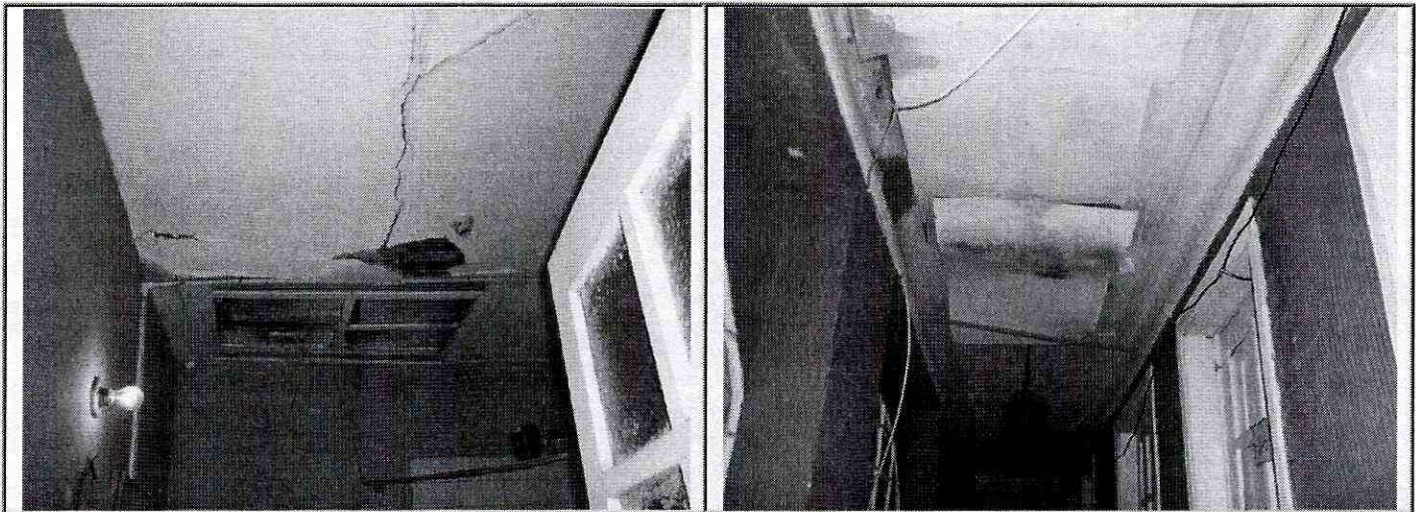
y 4 Vista de la zona de corredores de acceso y circulación al interior de la vivienda
